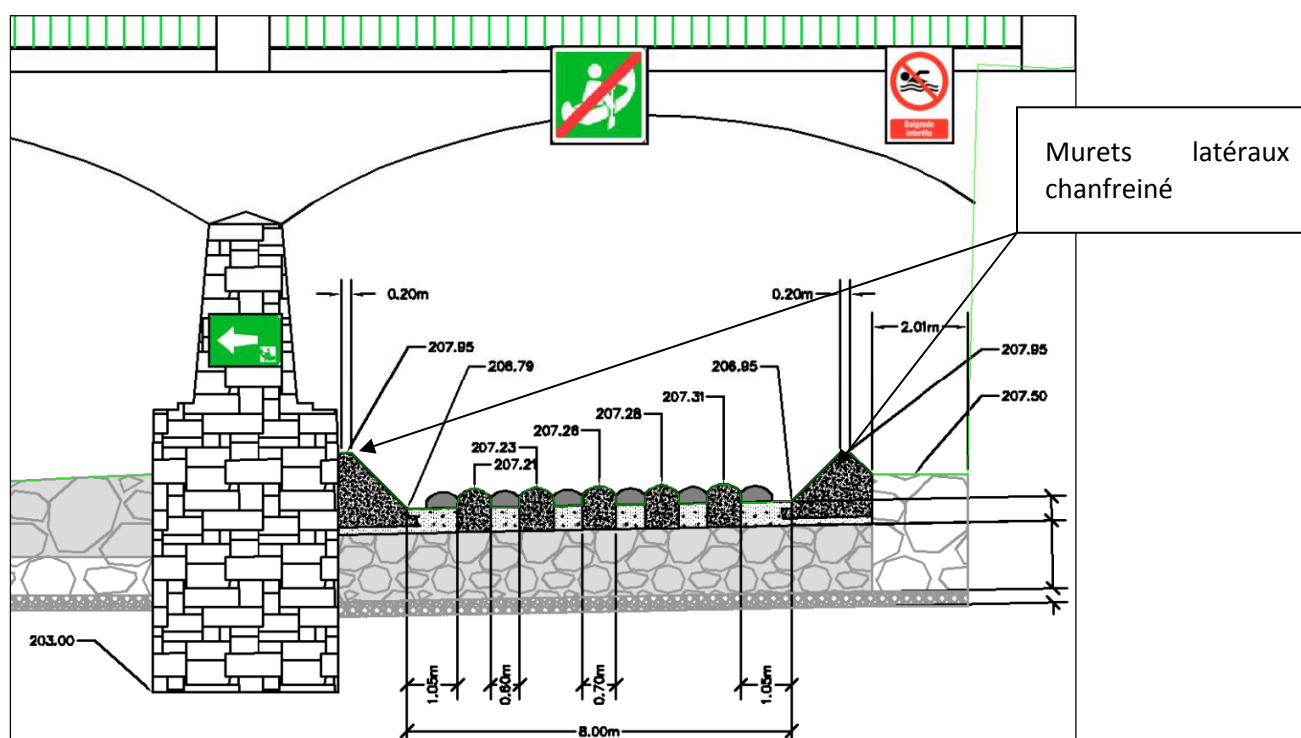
Vue en coupe de la passe à poissons au niveau du radier du pont
